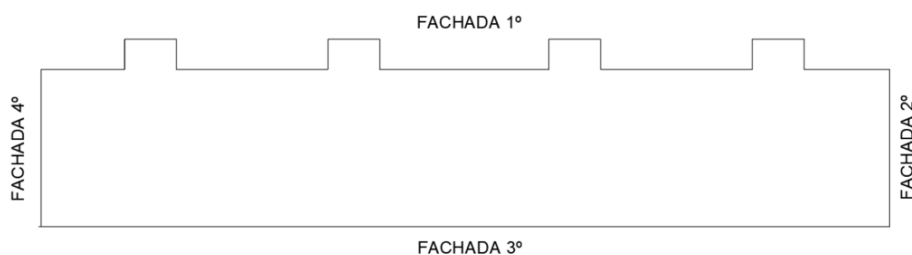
Divisão Inicial dos Lotes – R00 (Fonte: Autora)
